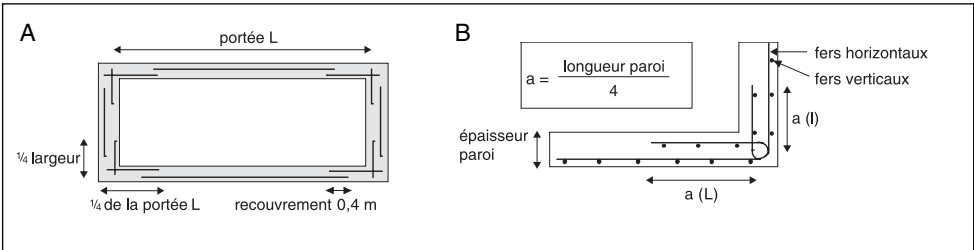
Ferrailage d’un réservoir rectangulaire. A, vue en coupe horizontale du ferrailage des parois. B, détail du ferrailage d’un angle, coupe horizontale.
